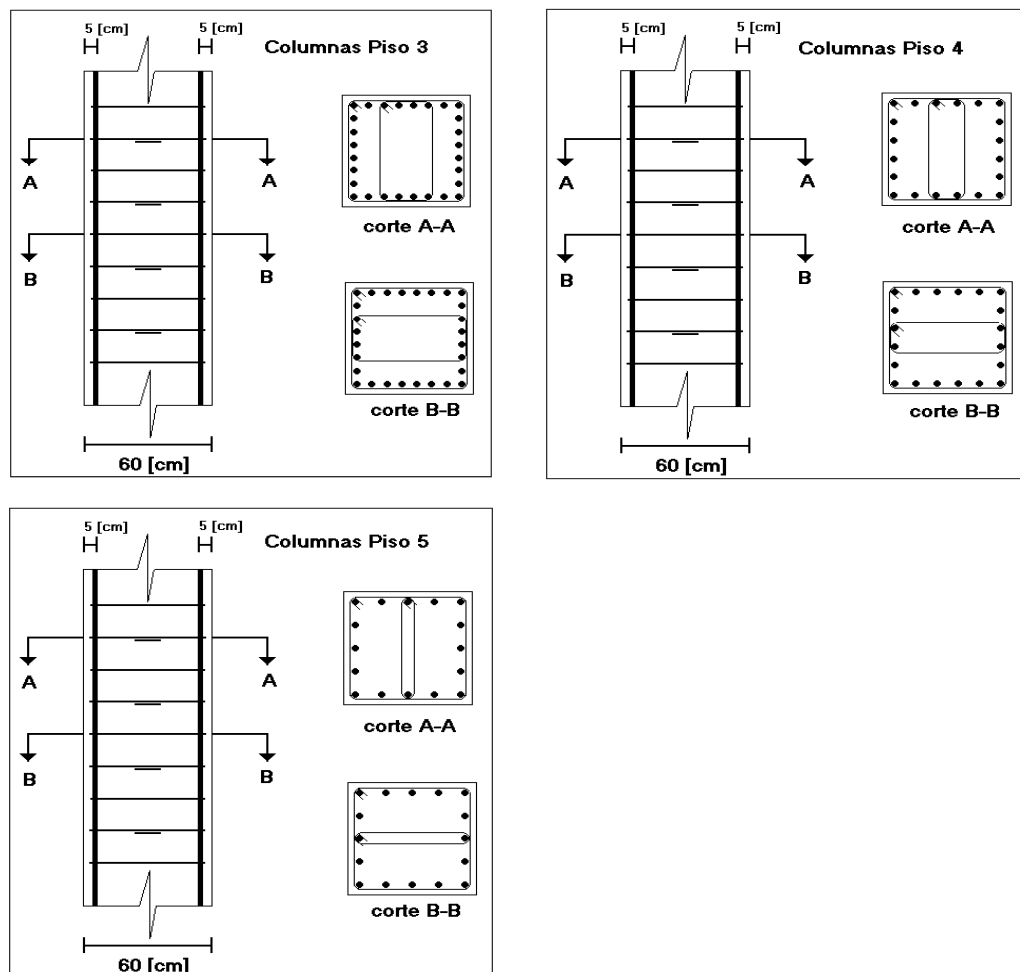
Detalle de la disposición de los estribos en las columnas del piso 3, 4 y 5.
